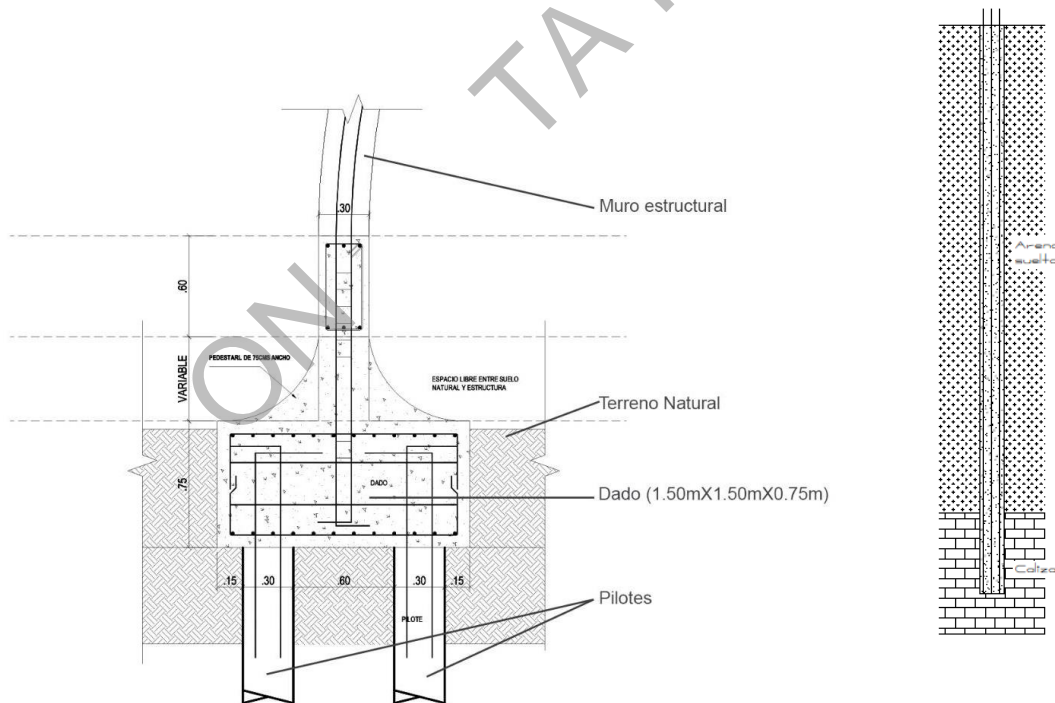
Perfil y detalles de pilotes para el hincado de módulos
